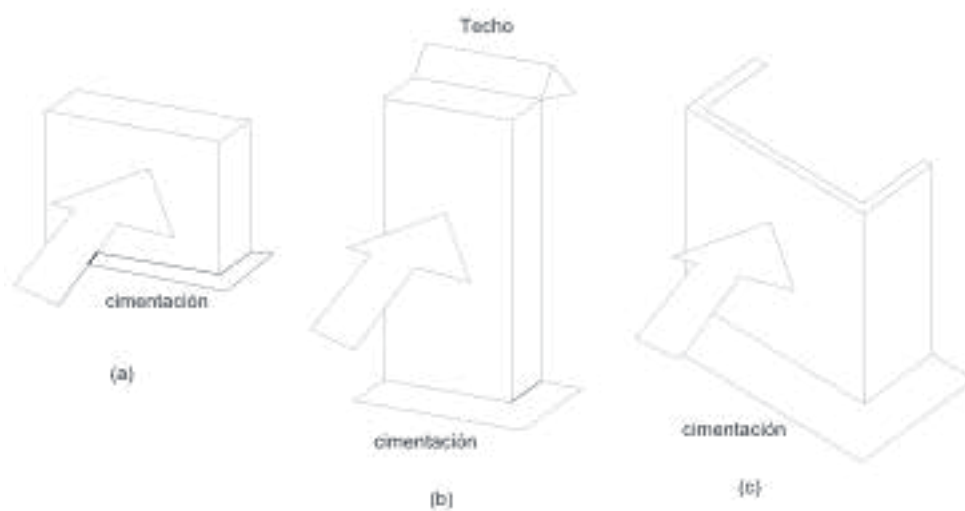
Comportamiento estructural de un muro ante cargas fuera del plano
